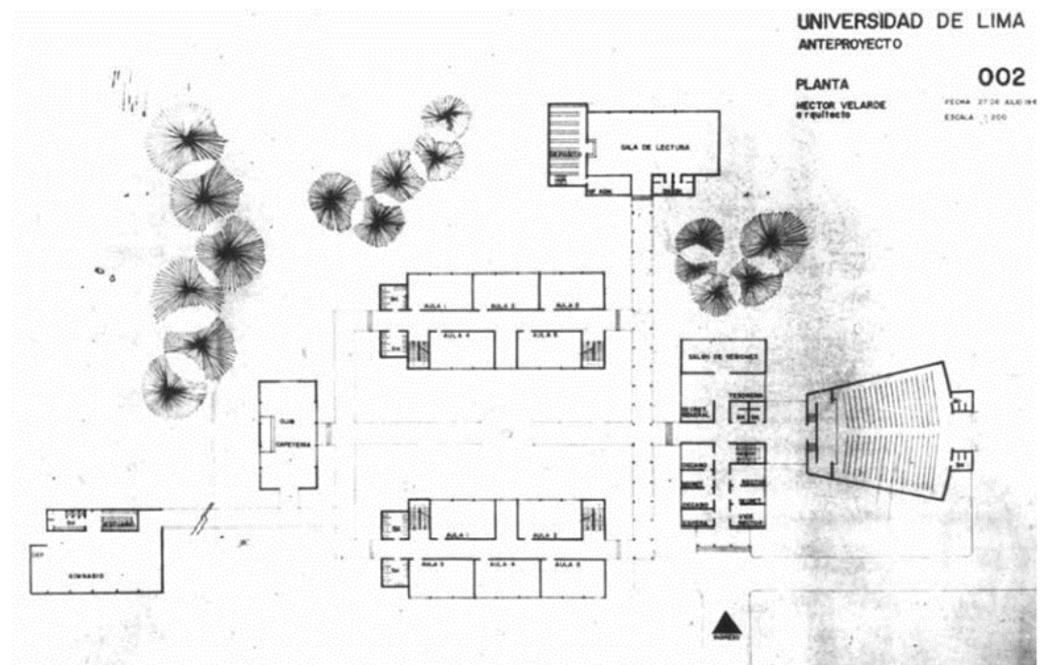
Planta general del anteproyecto de Héctor Velarde, 1964.
